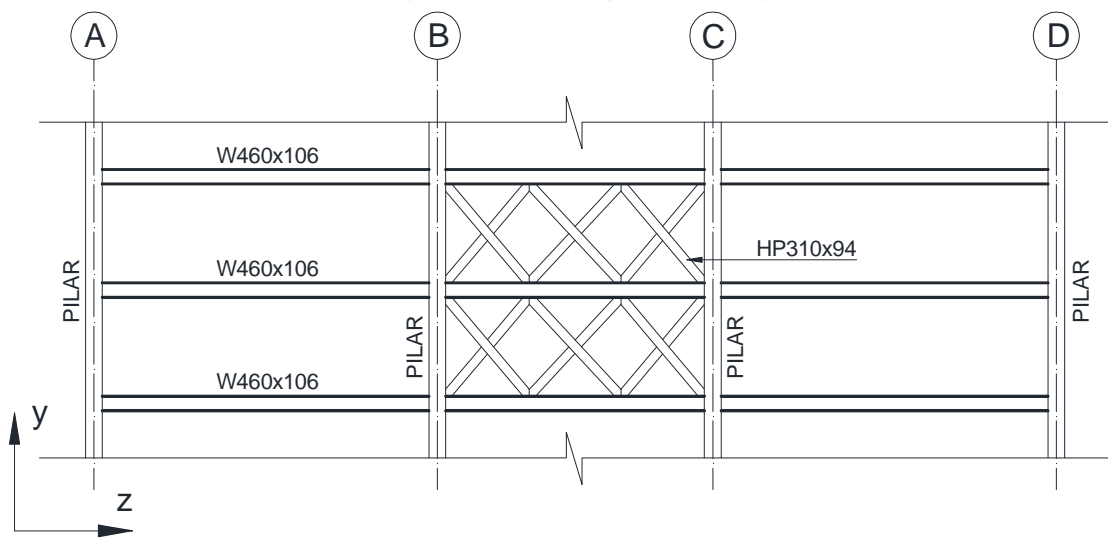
Planta baixa do pavimento tipo do modelo estrutural II (adaptada de Rios, 2015).
